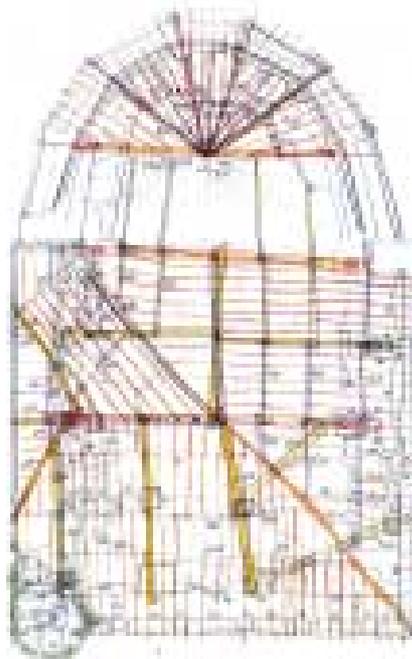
Croquis de la planta de cubierta de la capilla de Santiago
